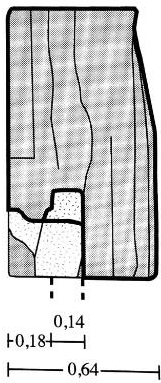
Plan de coupe du linteau 3 de la porte de Parménon : on y voit bien la cavité de pivot au centre, d'après GRANDJEAN 2011, p.532.
